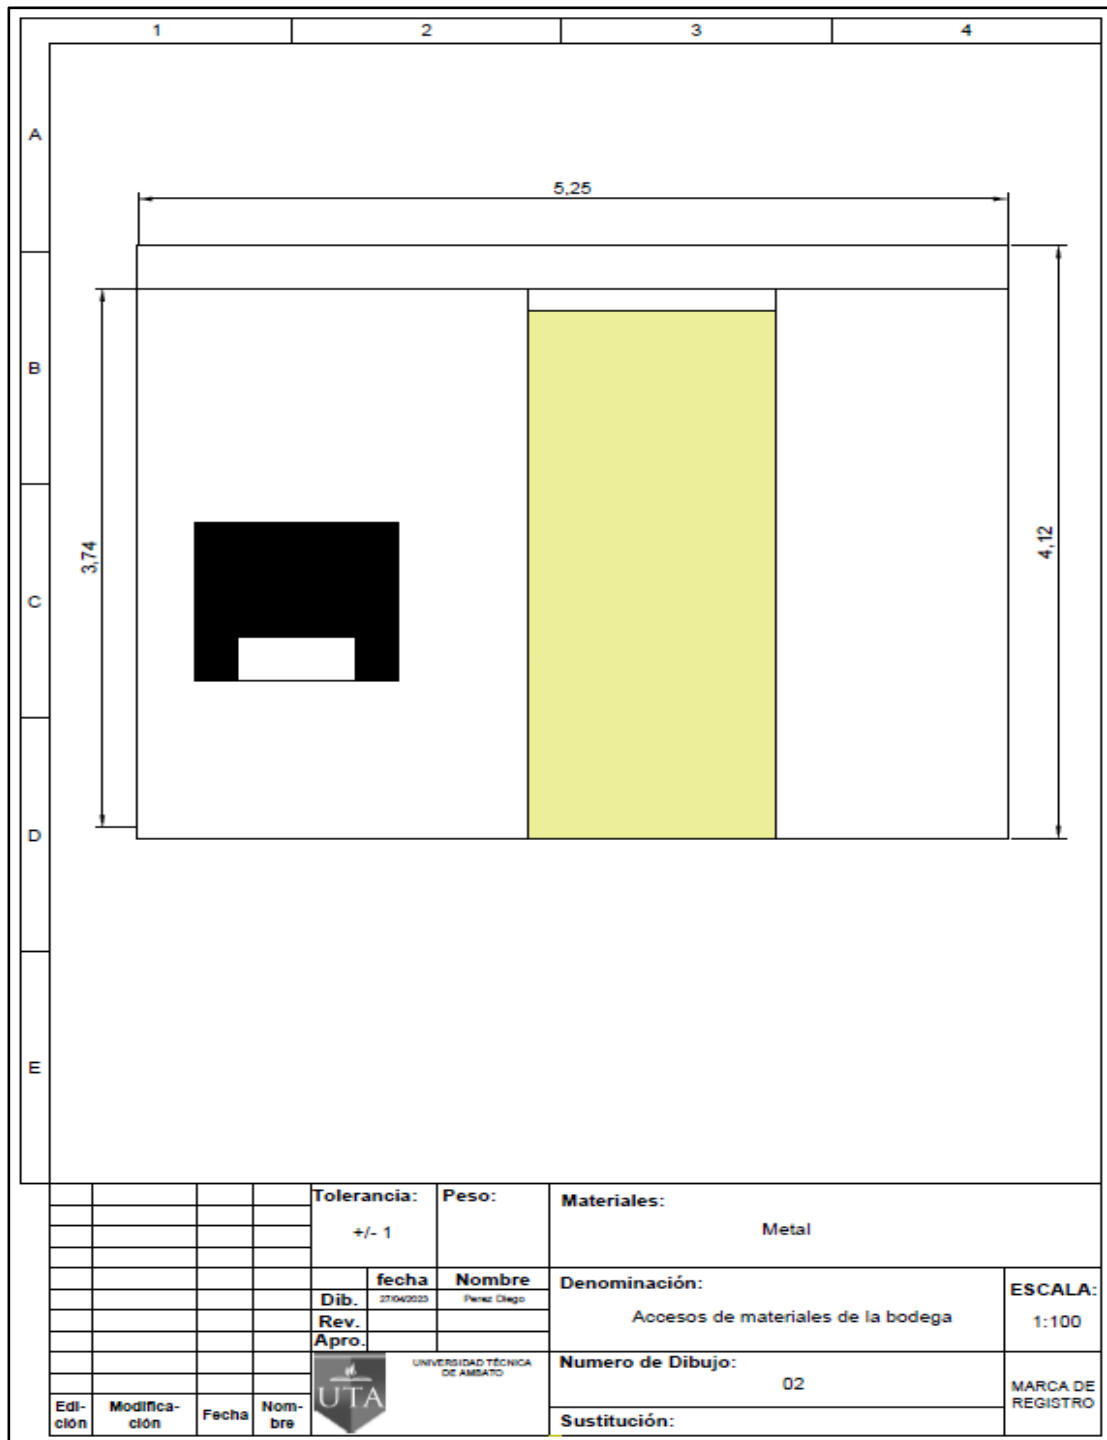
Layout de la bodega de la empresa DAVMOTOR vista frontal
